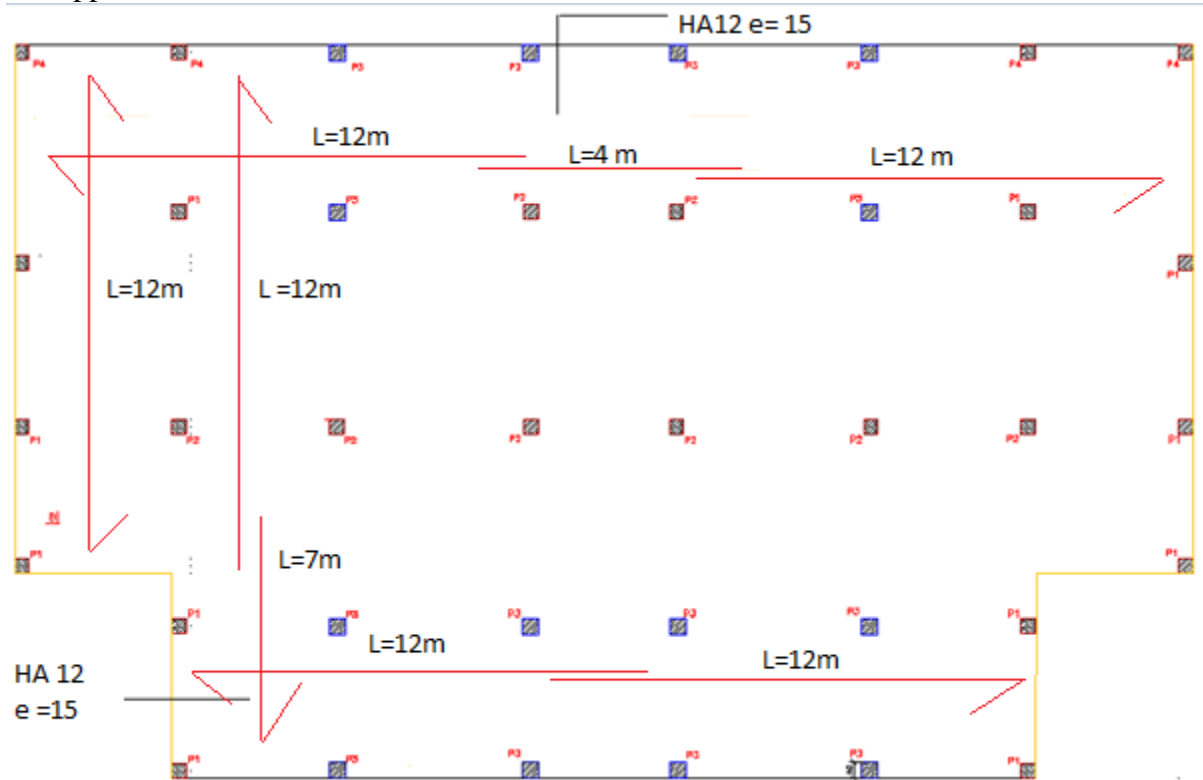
Les Plans de Coffrage et Ferrailage du Radier
